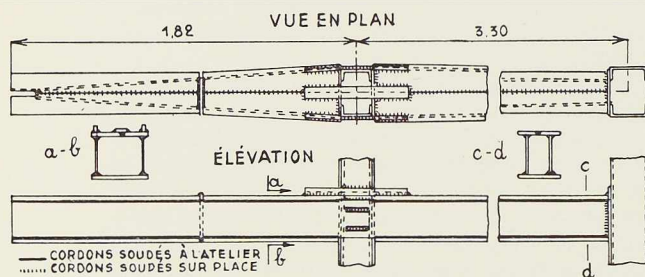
Poutre en forme de bateau supportant l'escalier.
